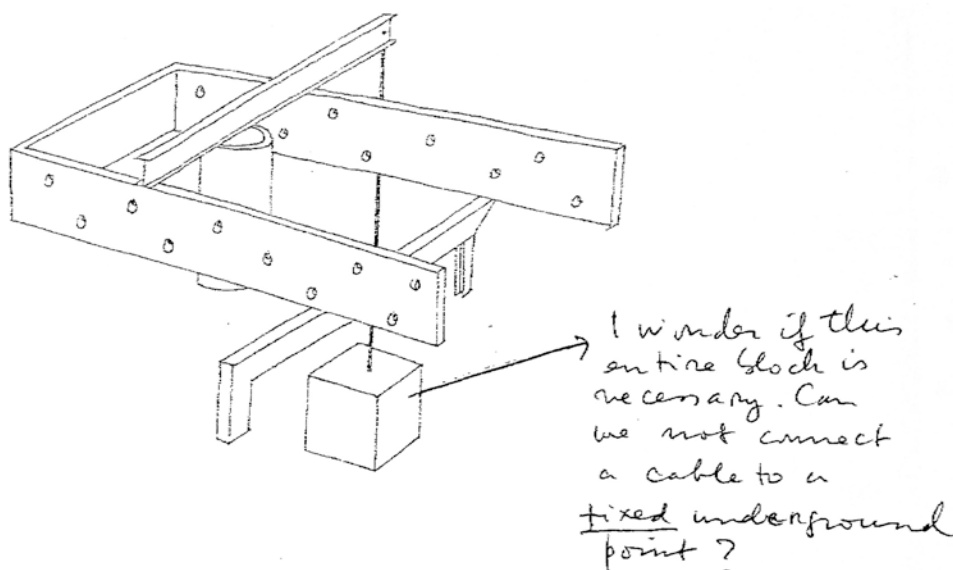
Croquis de esquema estructural con anotación de R.Koolhaas. Fax de obra 16/03/1996
